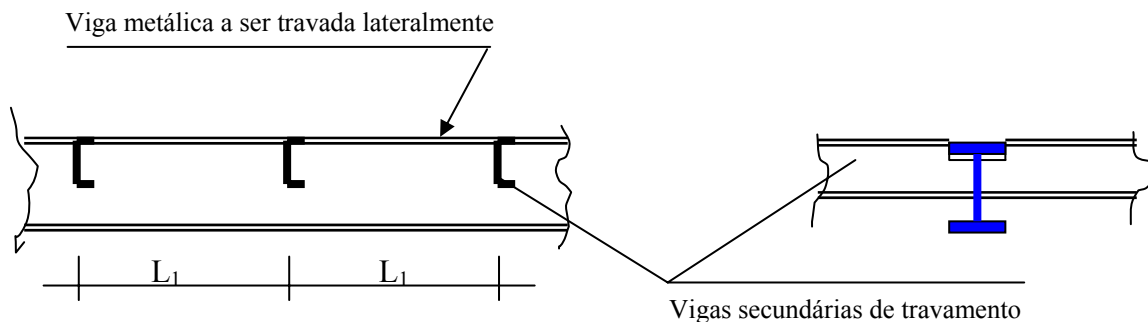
Travamento lateral isolado da fibra comprimida de uma viga metálica, através de vigas metálicas secundárias
